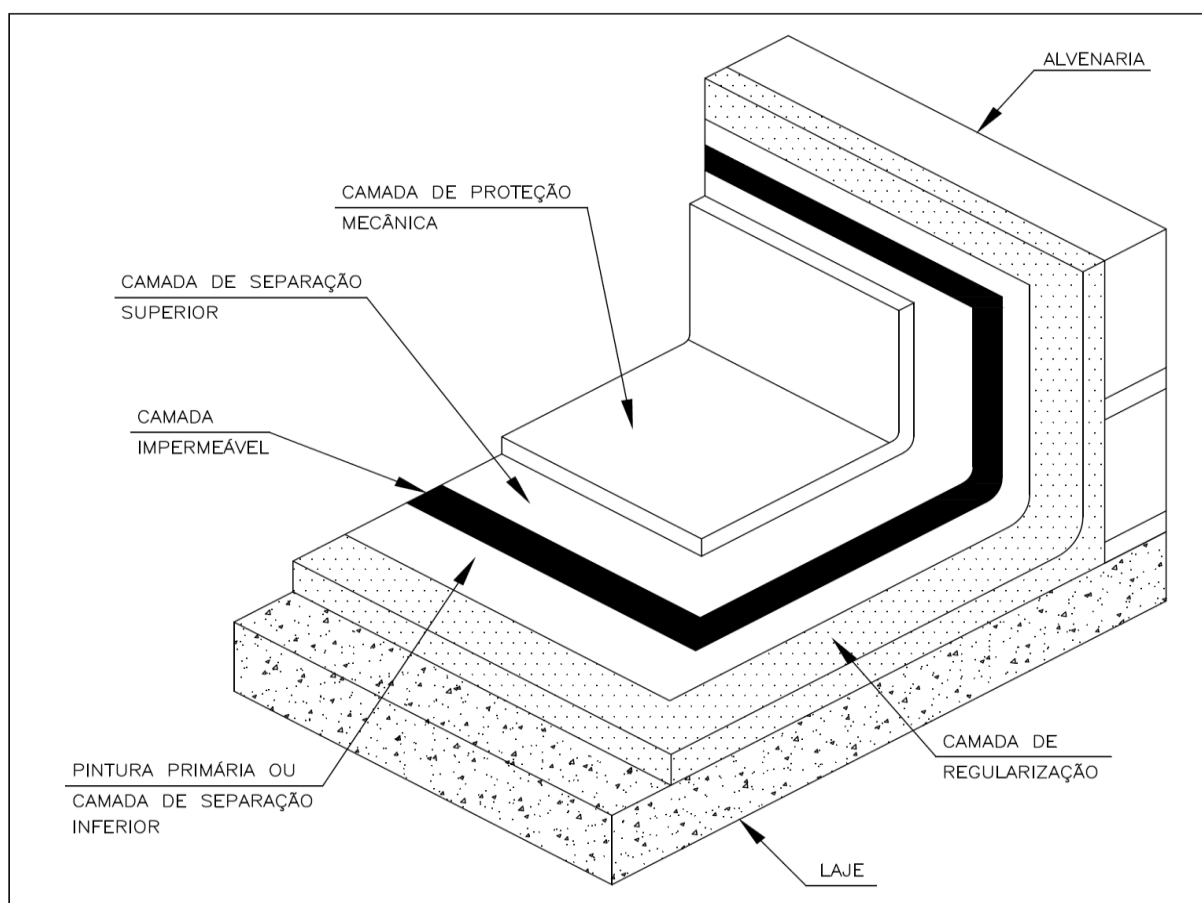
Camadas genéricas de um sistema de impermeabilização
